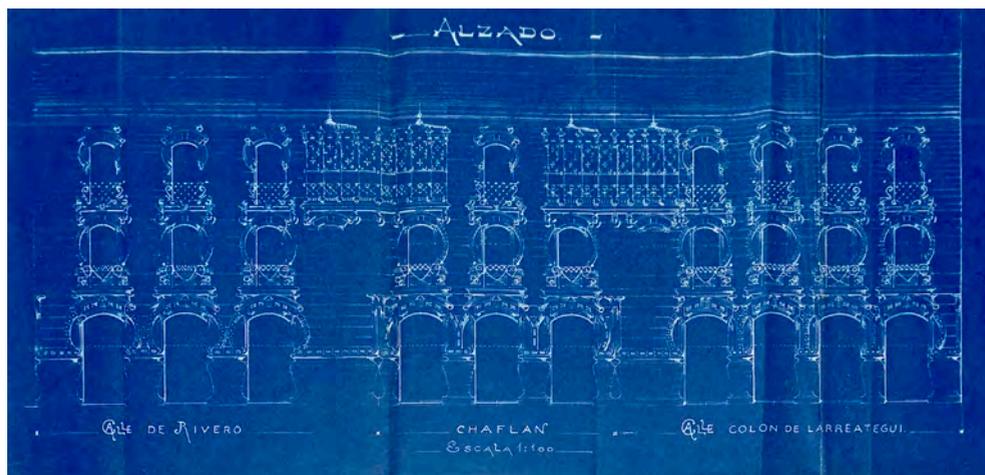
Alzado de las fachadas de la casa de Tomás Echave. Maestro de obras Francisco Arias. 1903. Ángulo entre las calles Iparraguirre y Colón de Larreátegui. Bilbao. (Derribada). (AHFB, Municipal, Bilbao, 5, 238, exp. 34)
